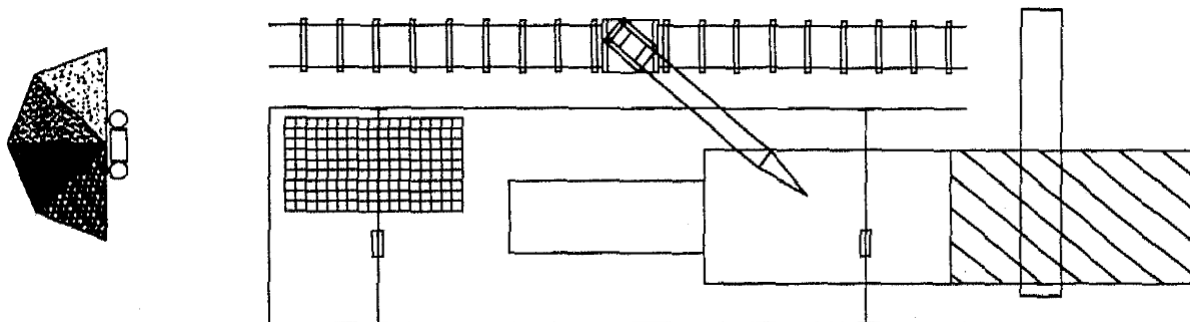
Exemplo de planta para um estaleiro de MLI.
